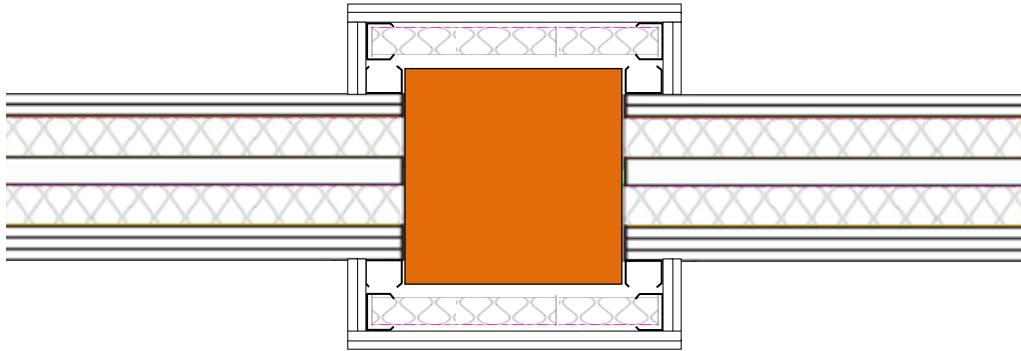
Détail d'encoffrement de la poutre et muralière
